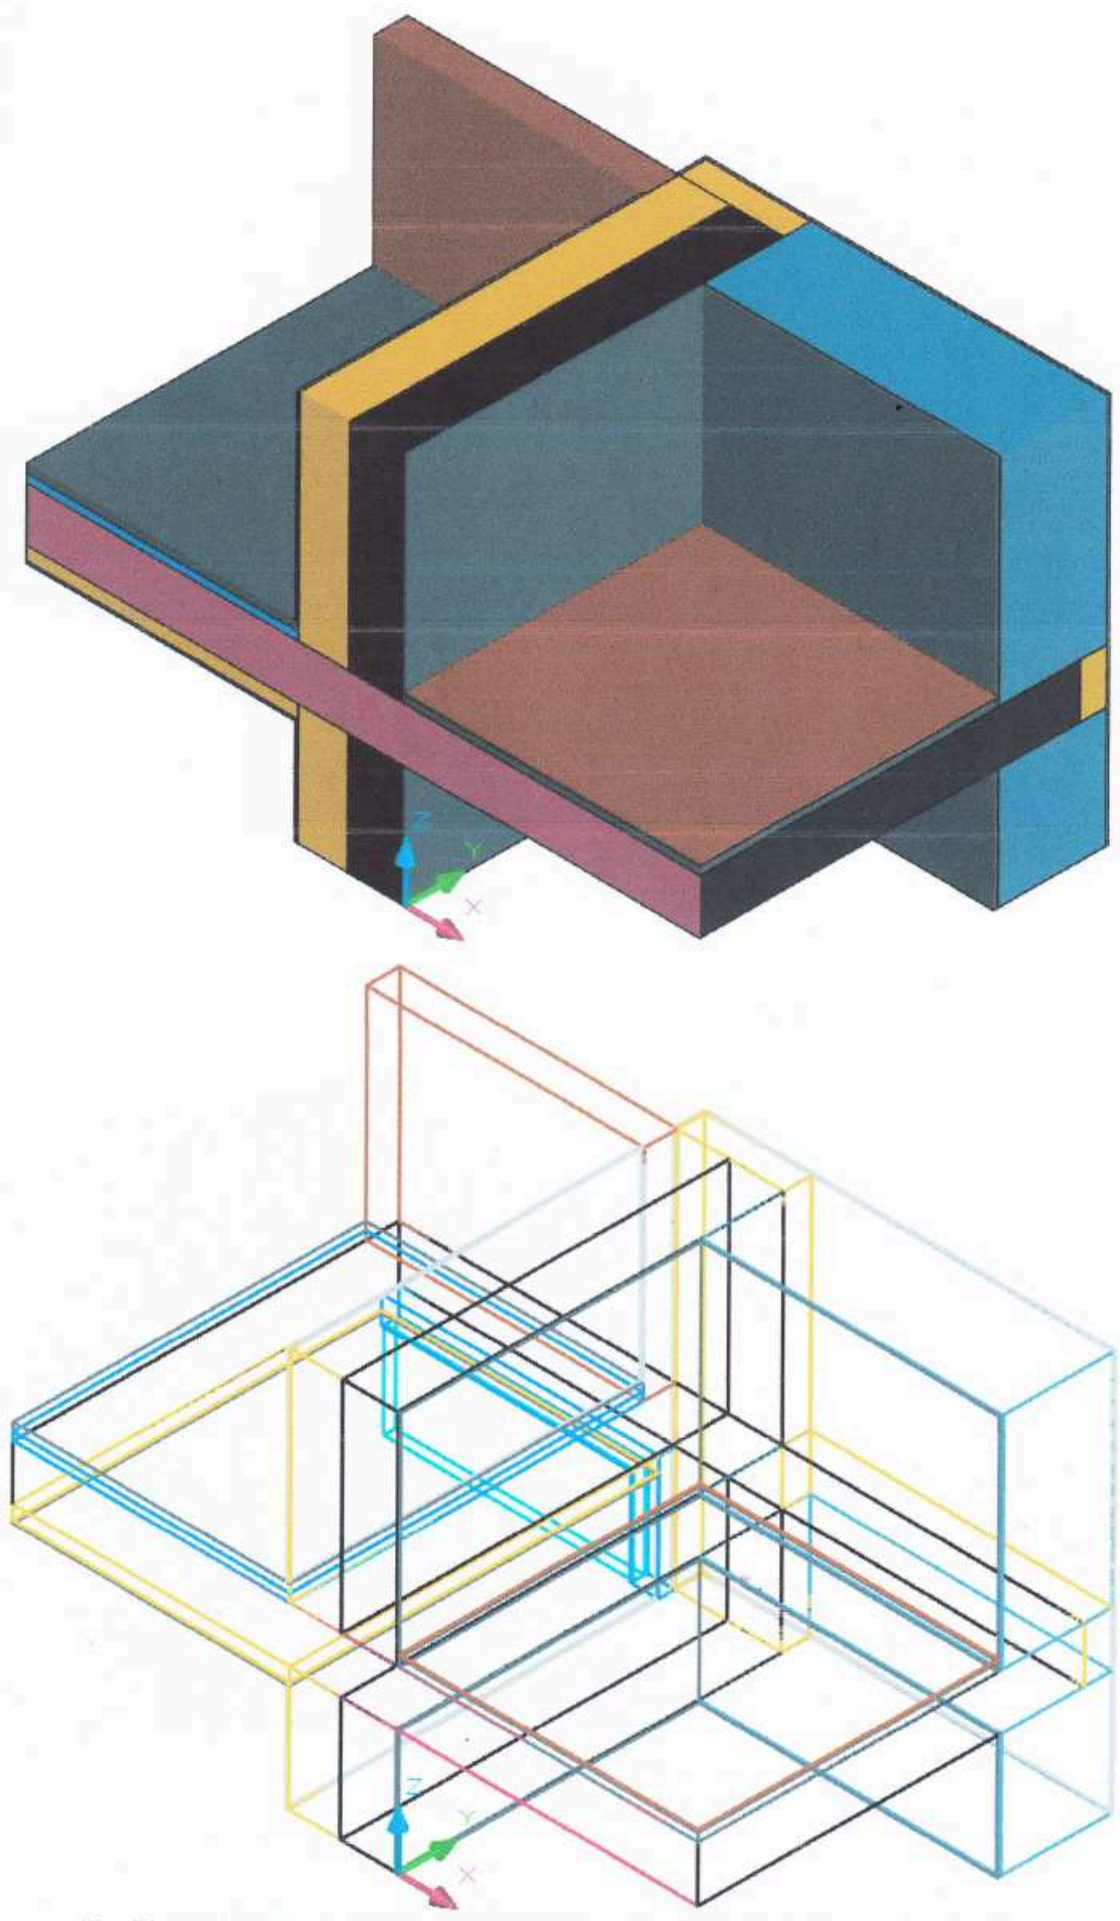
Расчетная схема узла сопряжения наружной стены и перекрытия (без перфорации диска пенополистирольными плитами)
